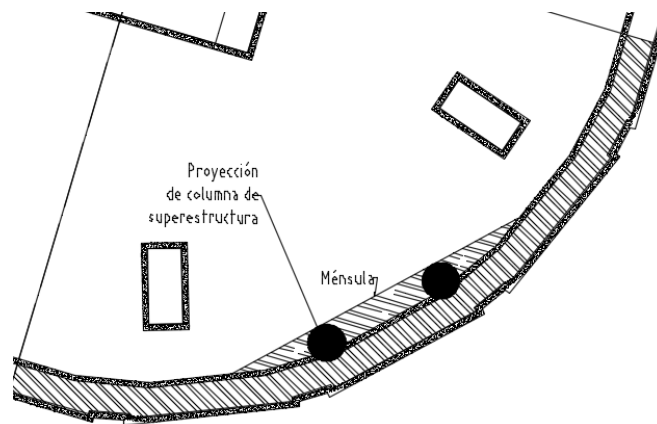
Sección en donde se vacía el concreto. Primer Tramo.⁴⁷
